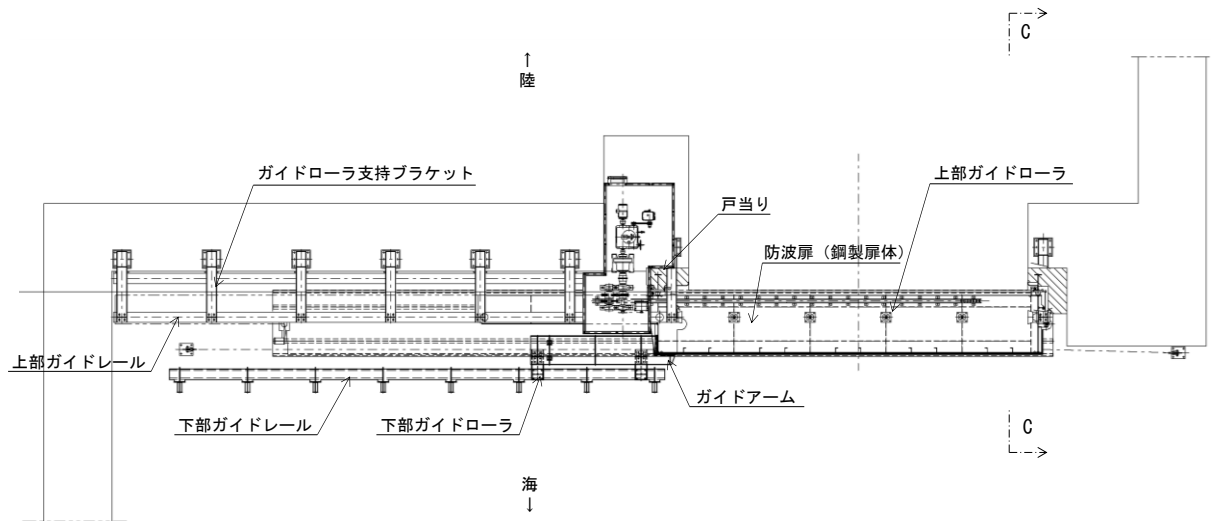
(2) 防波扉の構造図 (B-B断面)
